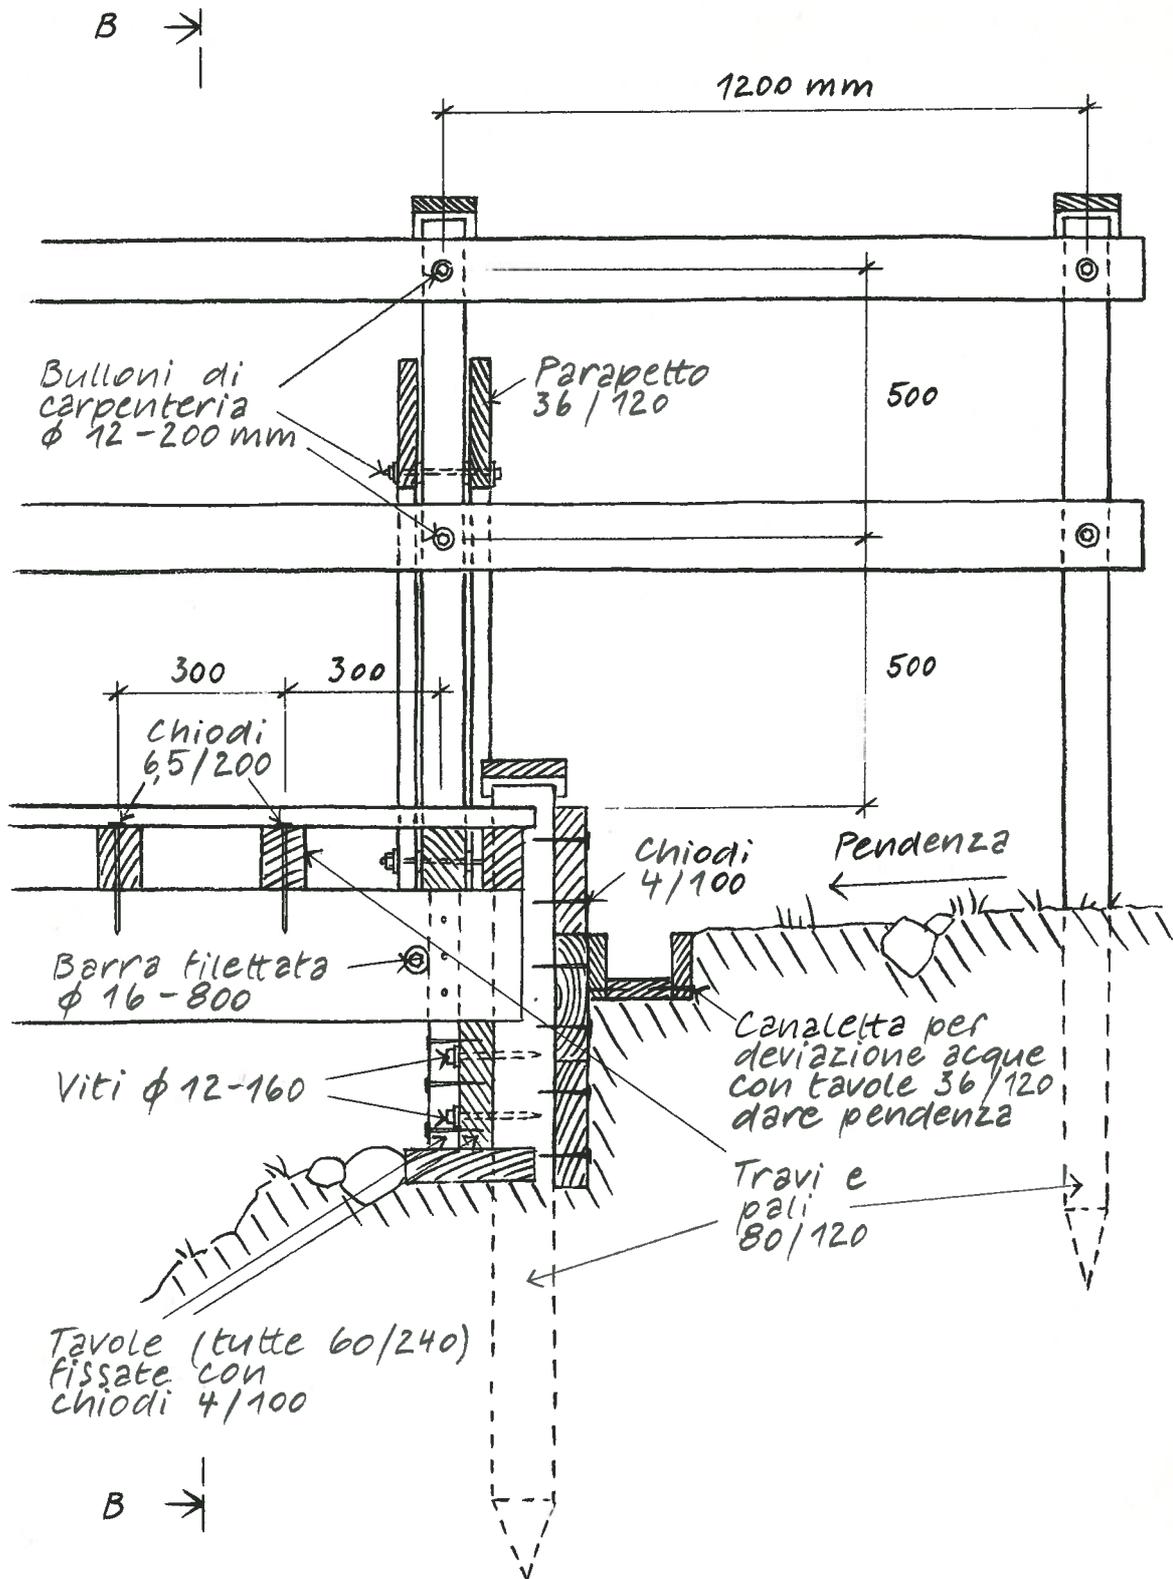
c: Passerella con legname segato, esecuzione standard; appoggi, sezione A-A
